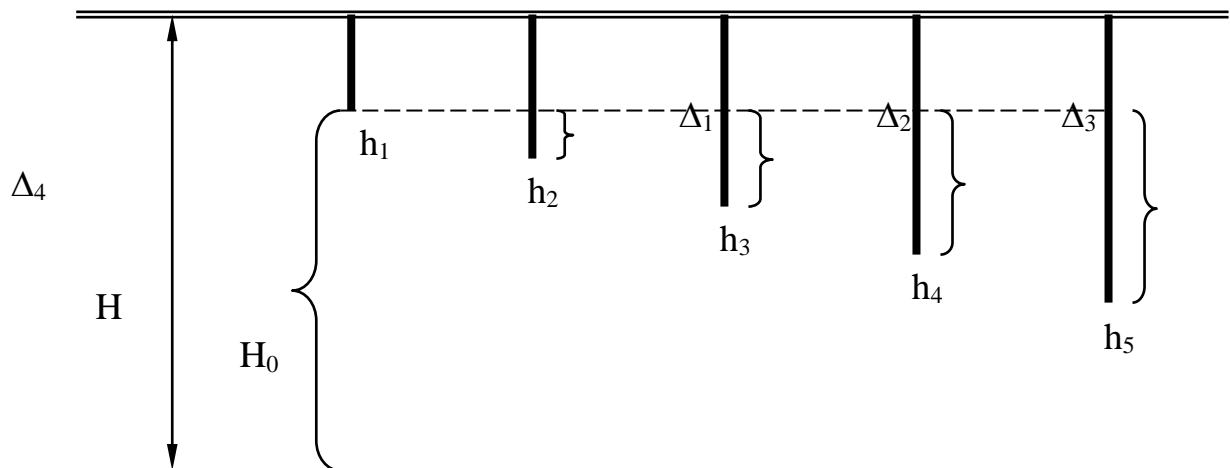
Схема розрахунку підвісок для кріплення трубопроводу
